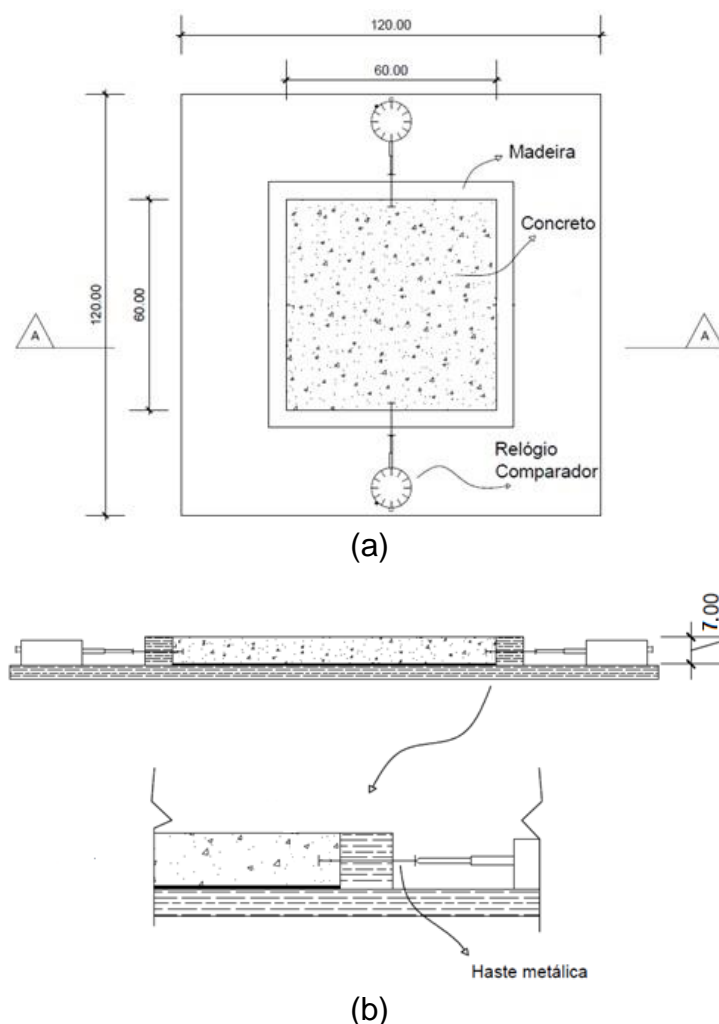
(a) Esquema da forma em planta (b) Corte longitudinal da forma
